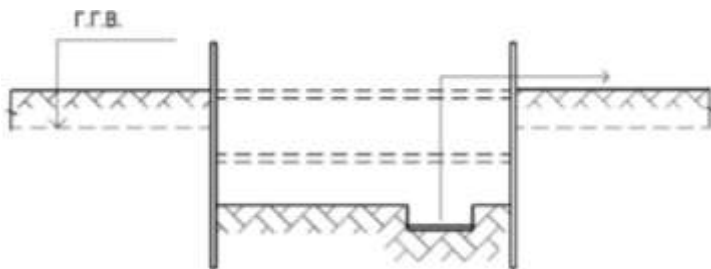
Технологическая схема открытого водоотлива из котлована, с откачкой воды насосами, в оплывающих неустойчивых грунтах, при креплении откосов
